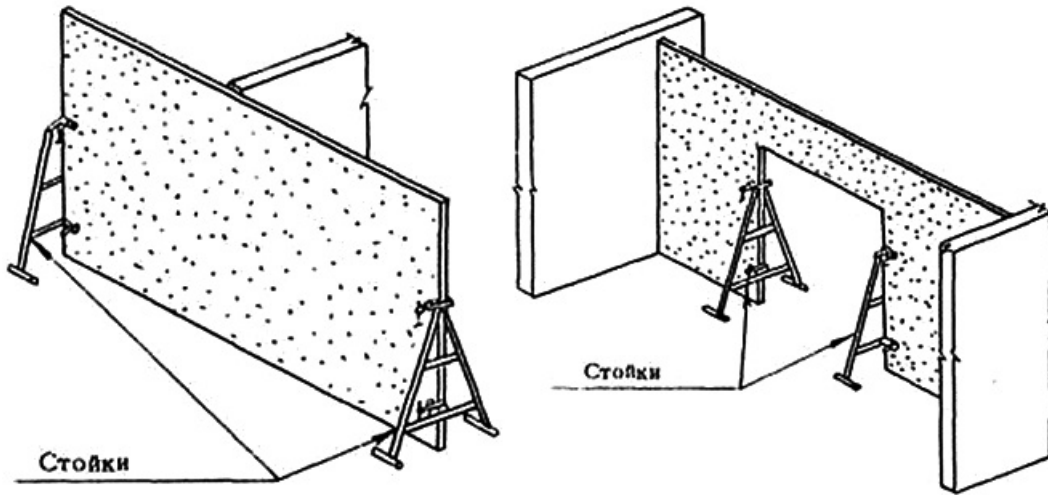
Временное крепление гипсобетонной перегородки с помощью стоек, установленных с её торцов и в проеме.
